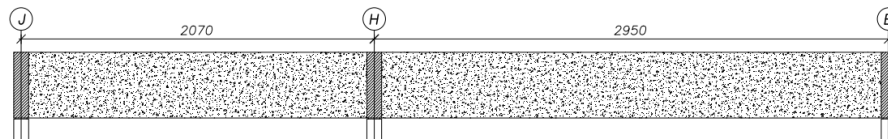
Corte Longitudinal da viga (dimensões em centímetros).
